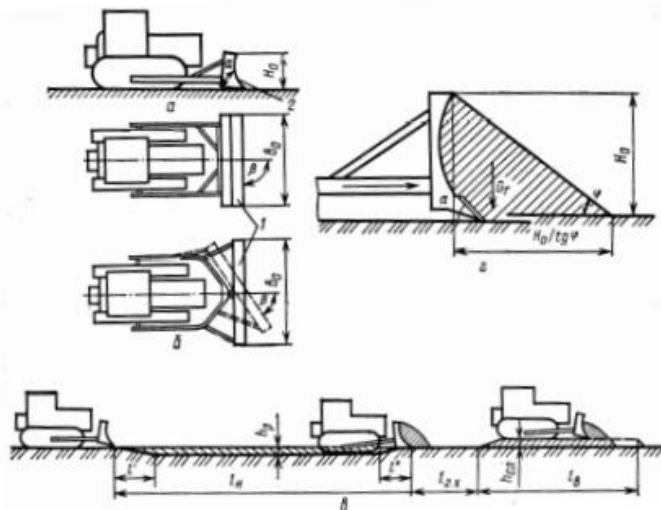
Схемы работы бульдозеров: а – с неповоротным отвалом; б – с поворотным отвалом; в – схема набора, перемещения и отсыпки грунта; г – схема к определению объема грунта перед отвалом бульдозера
